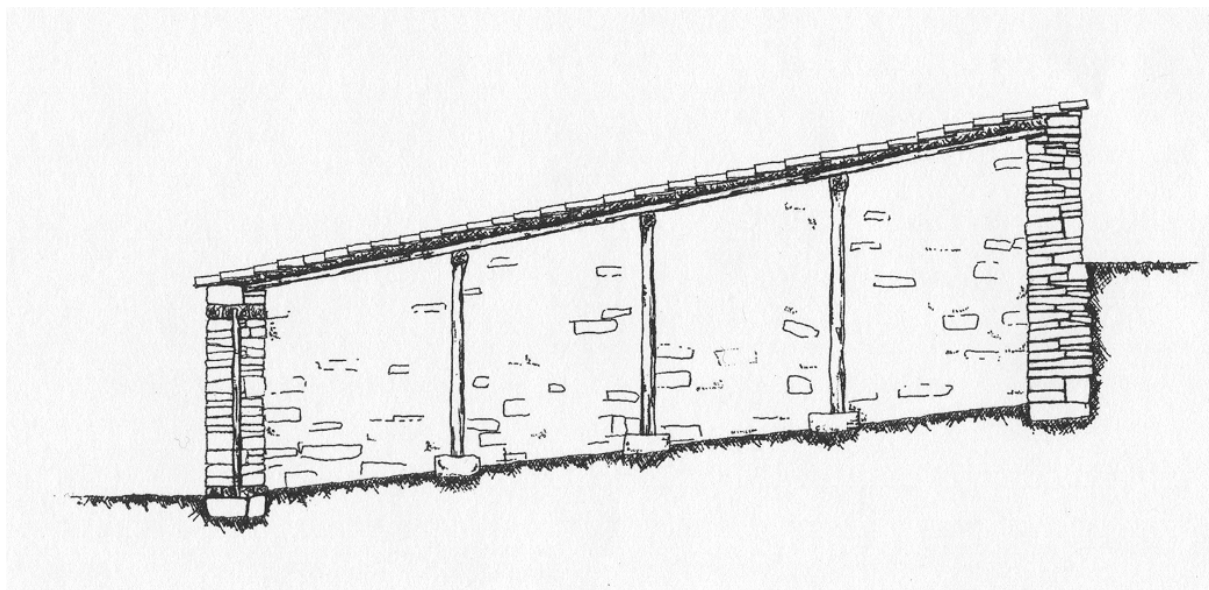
Parideras en Herrería (Guadalajara). Sección longitudinal
